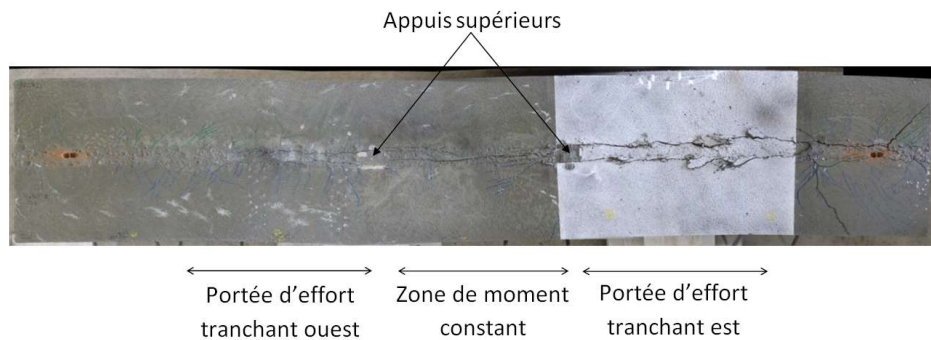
Fissuration de la table de la poutre BFUP B A
